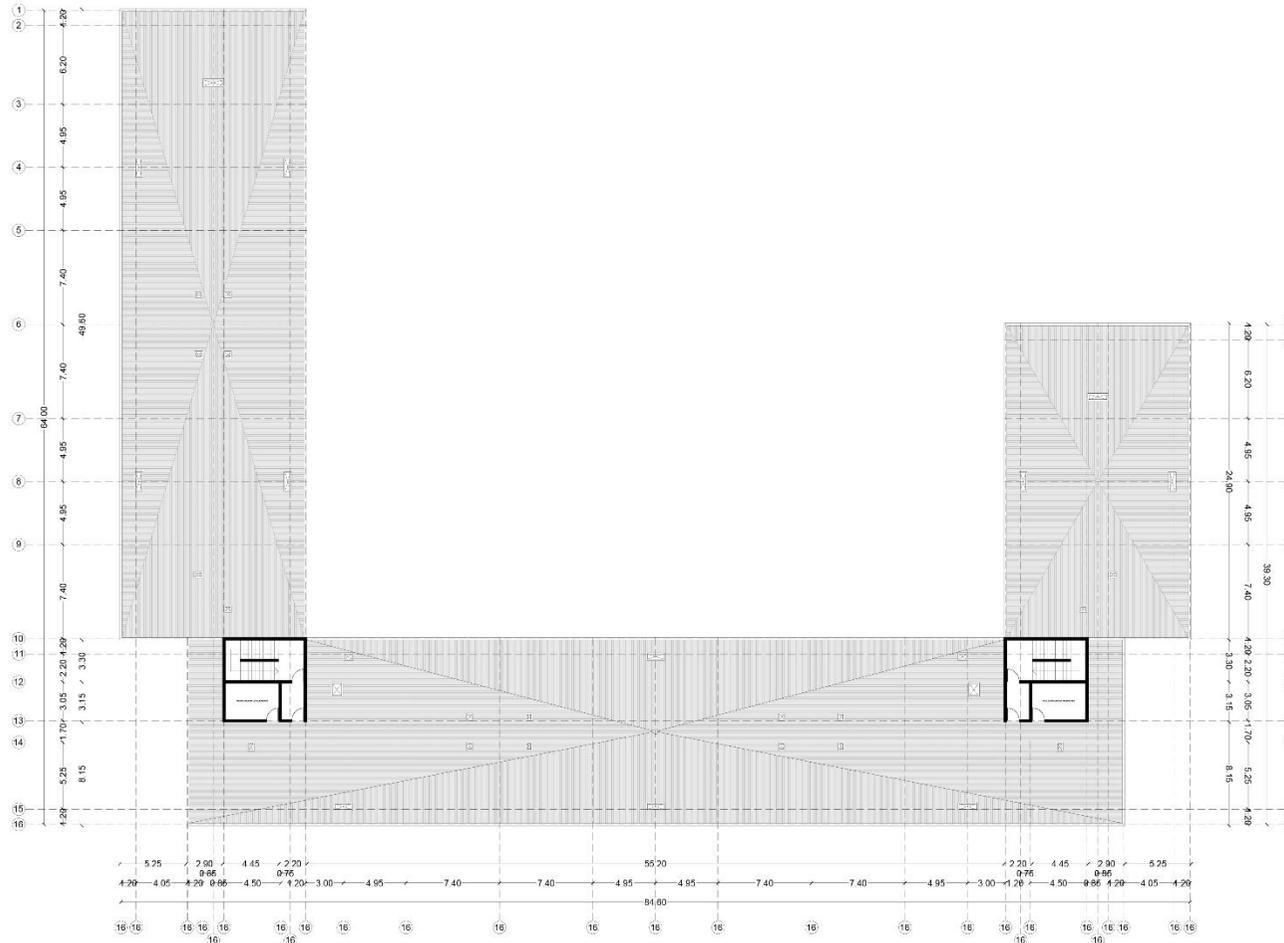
Planta de techo edificio 6/8 pisos, escala 1/300. Fuente: Elaboración propia.
